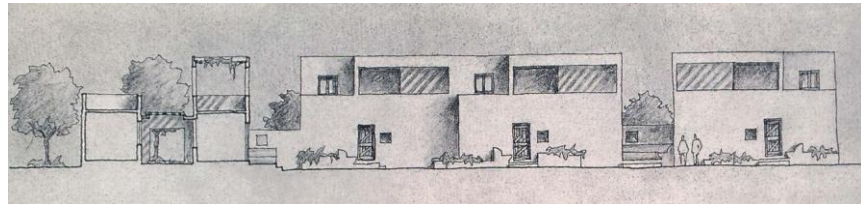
Sección y alzado para la agrupación de la tipología J
